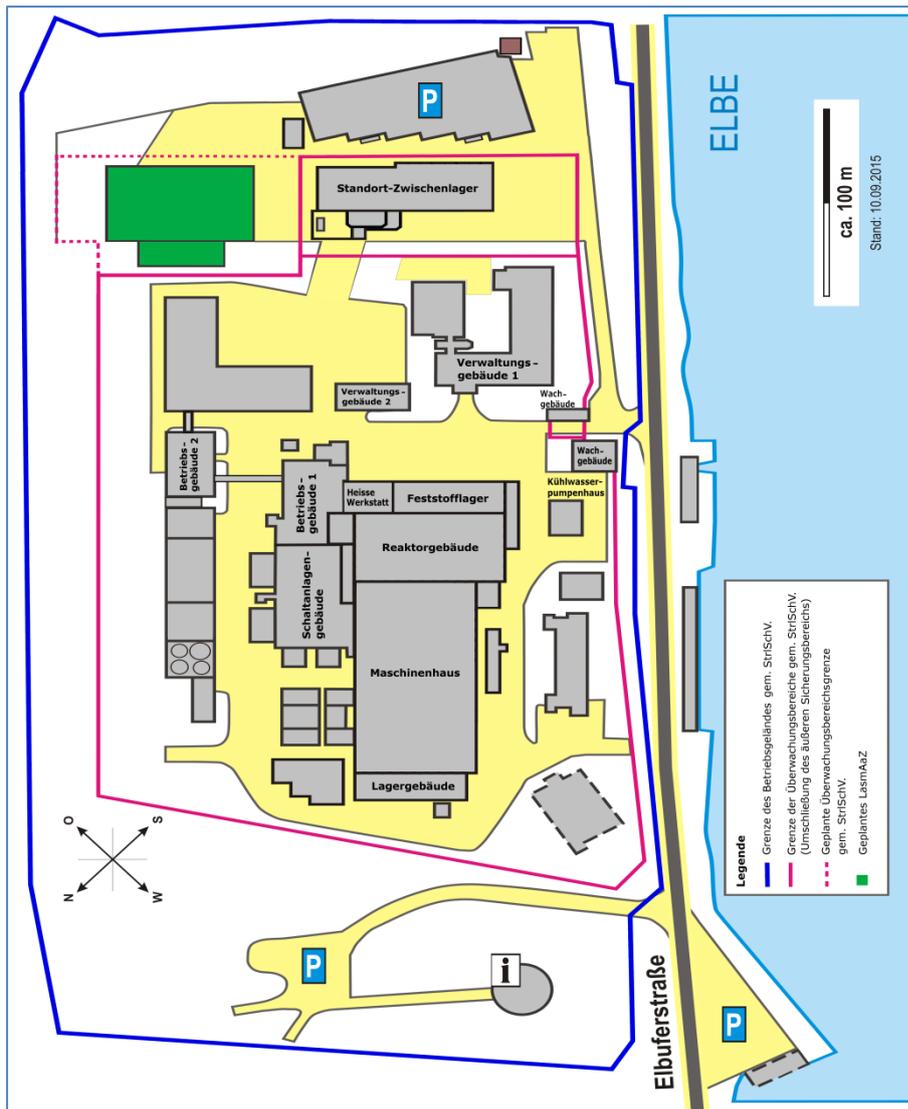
Lageplan des Kernkraftwerks Krümmel
